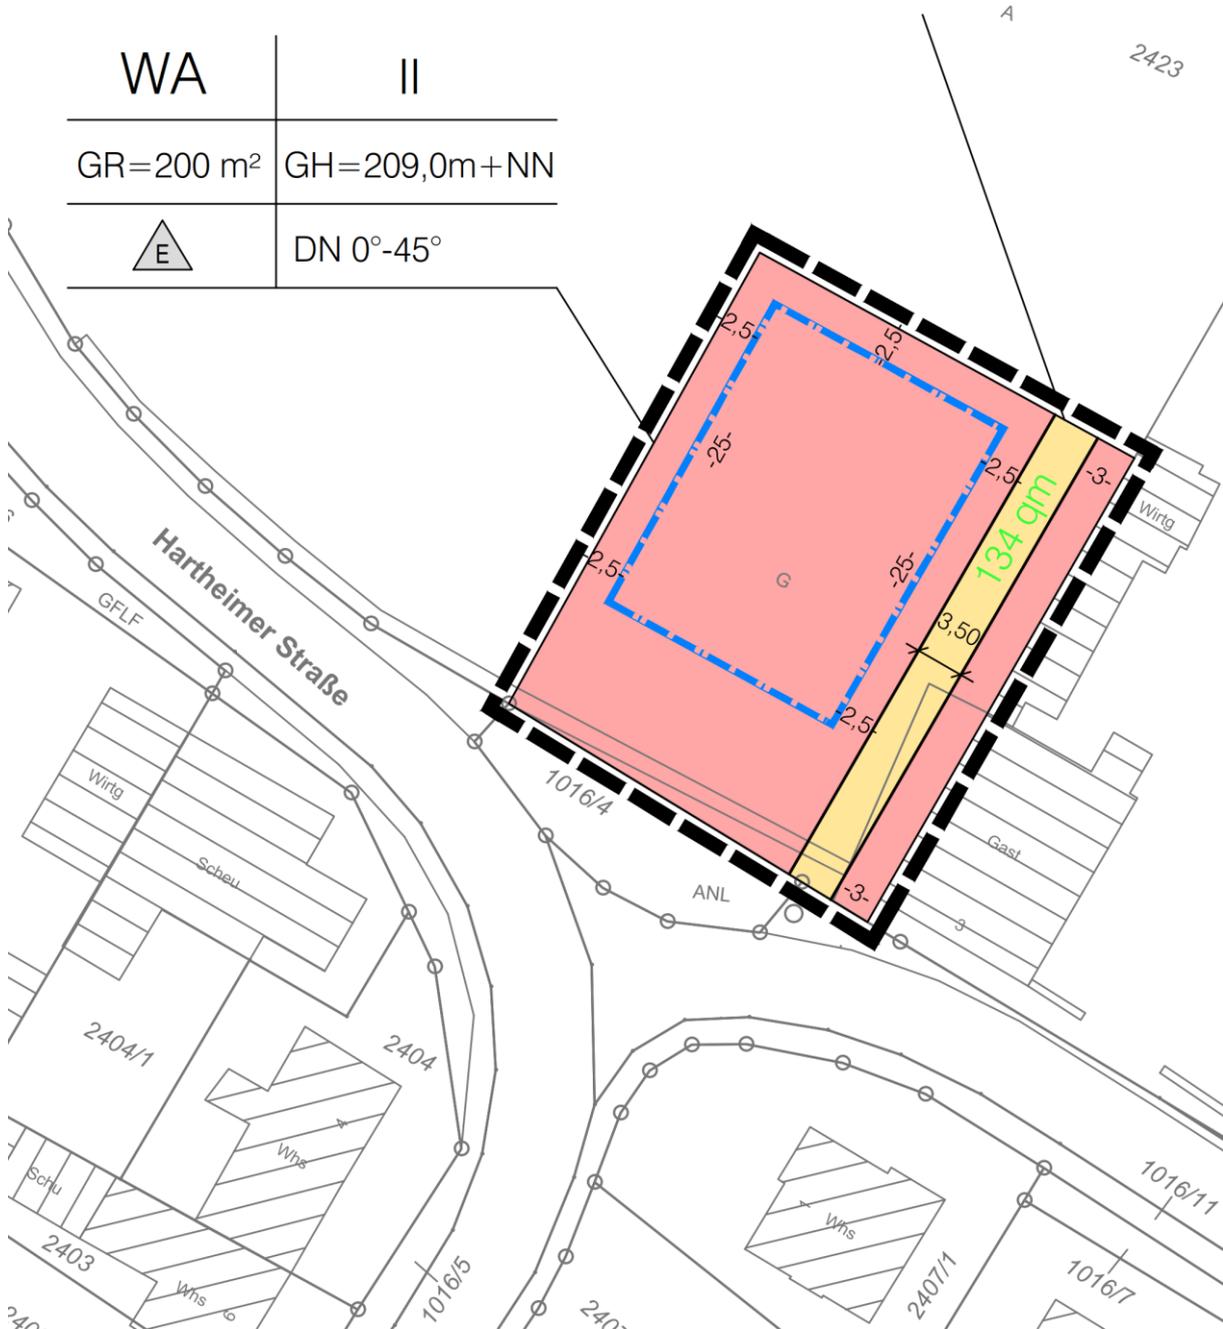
Bebauungsplan „Mohlinstraße“ (Auszug) o.M.
